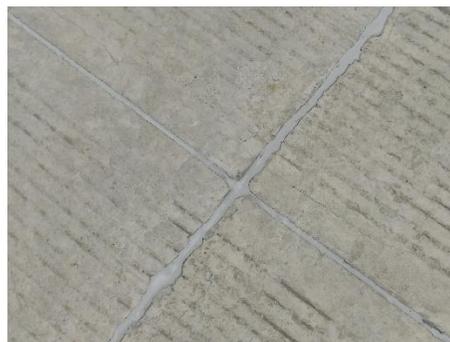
Acabado superficial del pavimento en eje 3.
